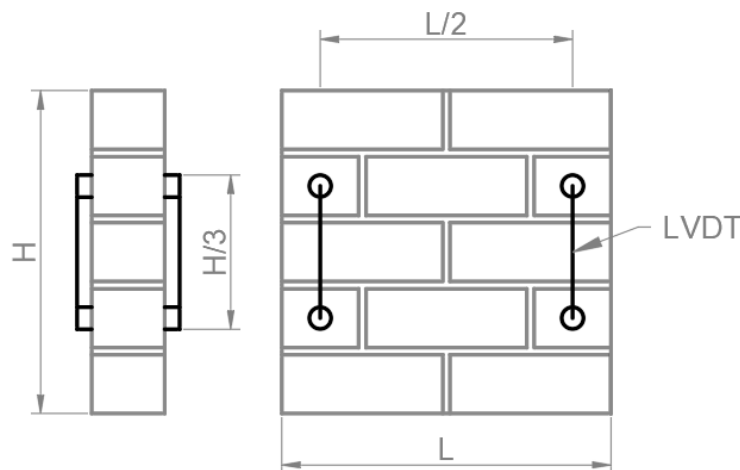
Instrumentação de alvenaria para ensaio à compressão.
